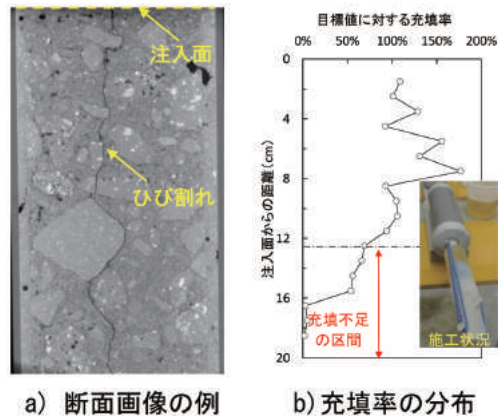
ひび割れ注入材により補修されたコンクリートのX線CTによる観察
